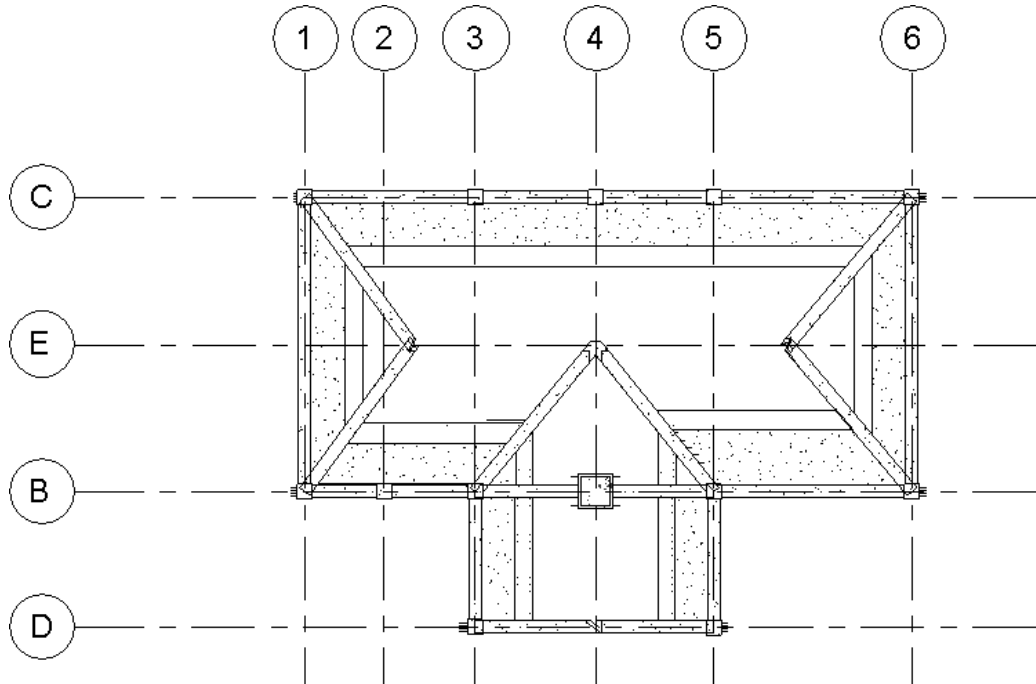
Plano de fundaciones con detallado acero del modelo estructural
